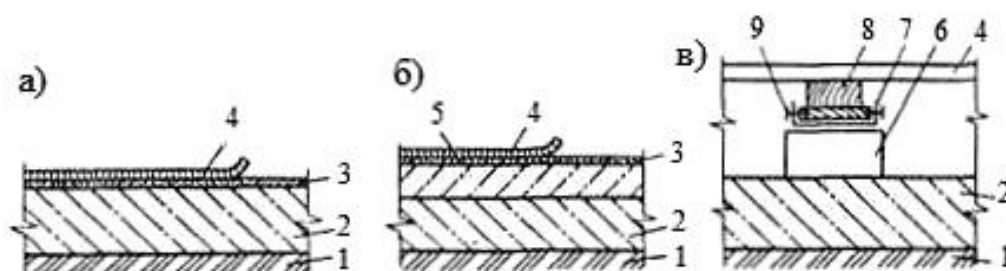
Види підлог по ґрунту: *а* – бетонна підготовка; *б* – утеплене покриття для підлоги; *в* – вид по лагам на стовпах; 1 – ґрунт, який ущільнюється; 2 – бетонна подушка; 3 – стяжка; 4 – накриття підлоги; 5 – утеплюючий шар; 6 – цегла; 7 – два шари руберойду; 8 – лага; 9 – антисептикована підкладка
